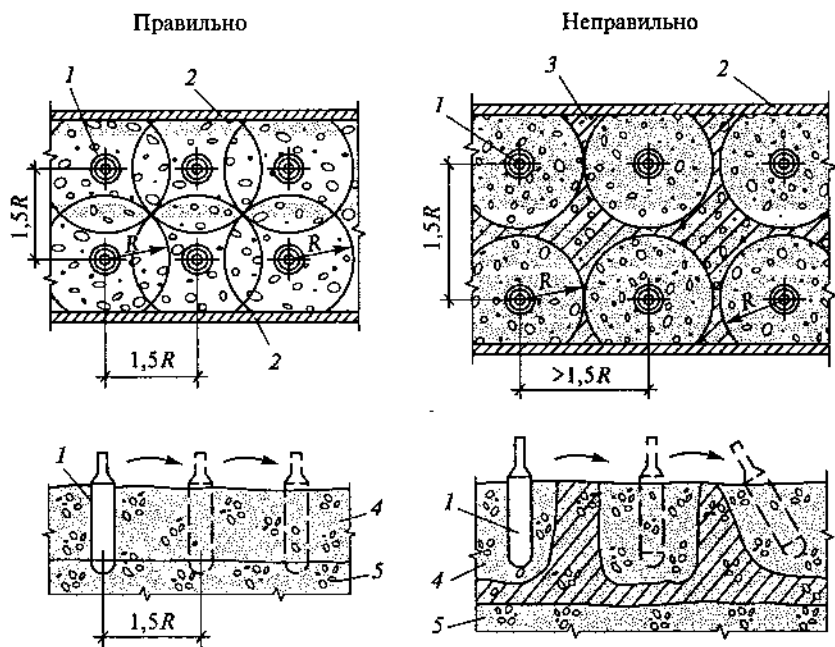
Правила укладки и уплотнения бетонной смеси:
